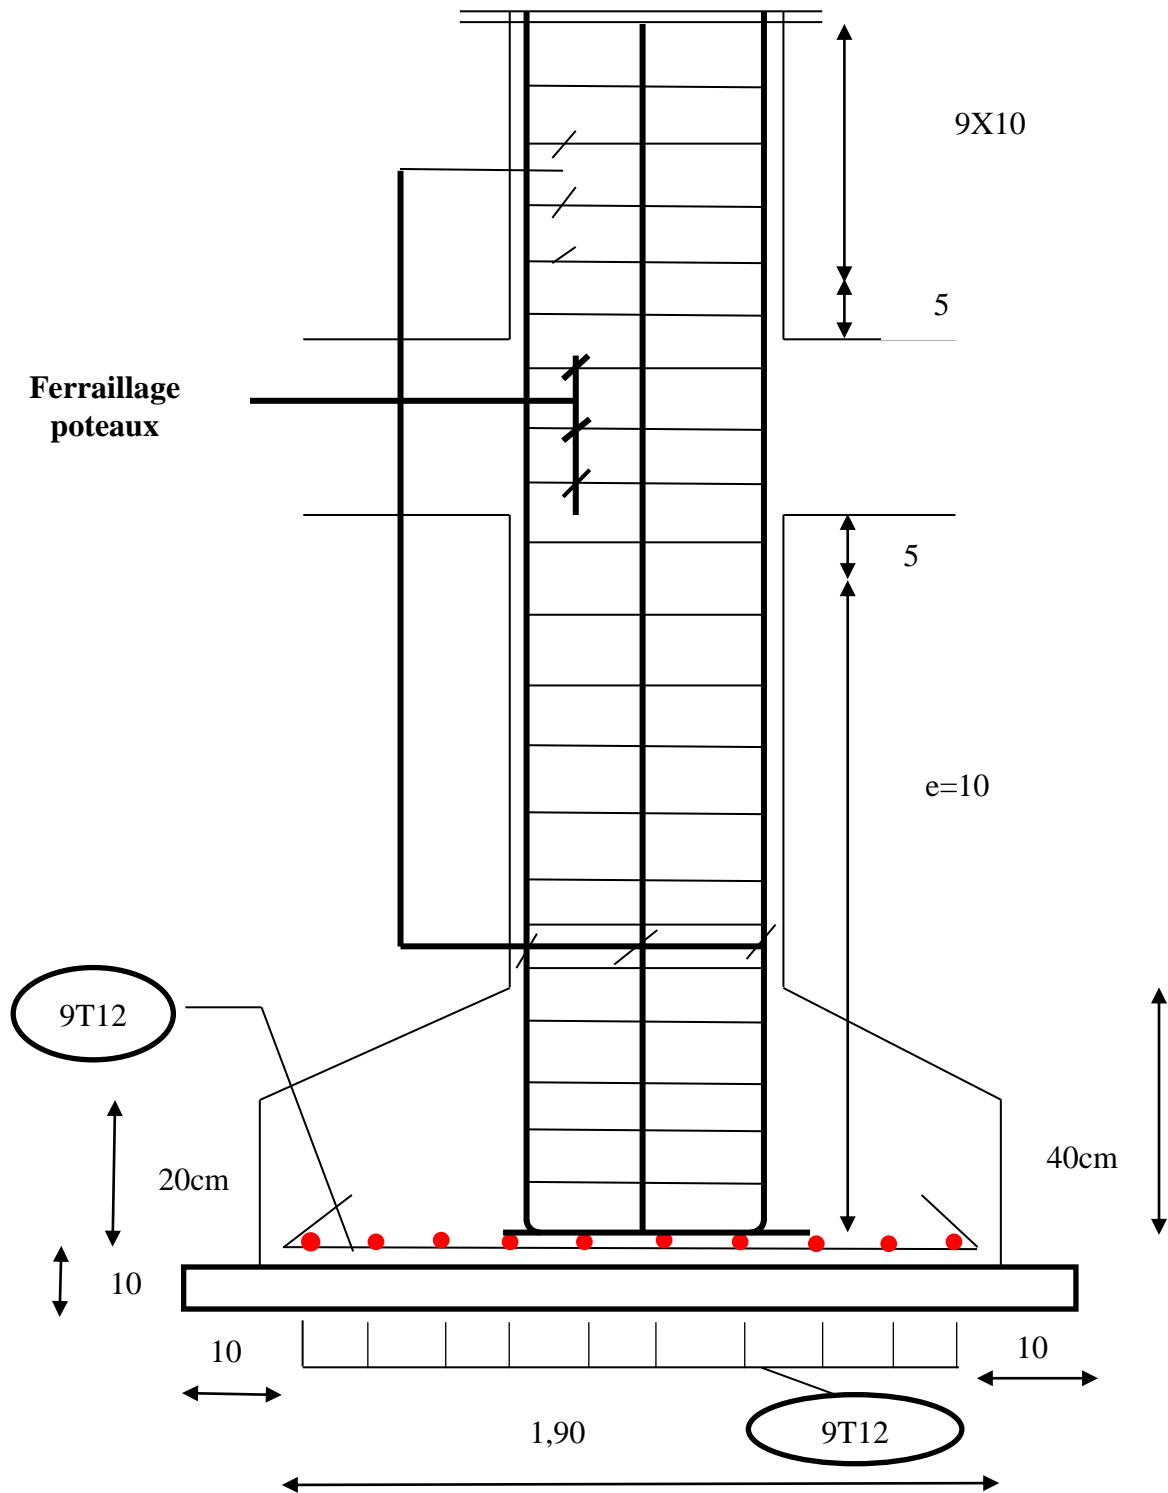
schéma de ferrailage semelle isolée sous poteau
